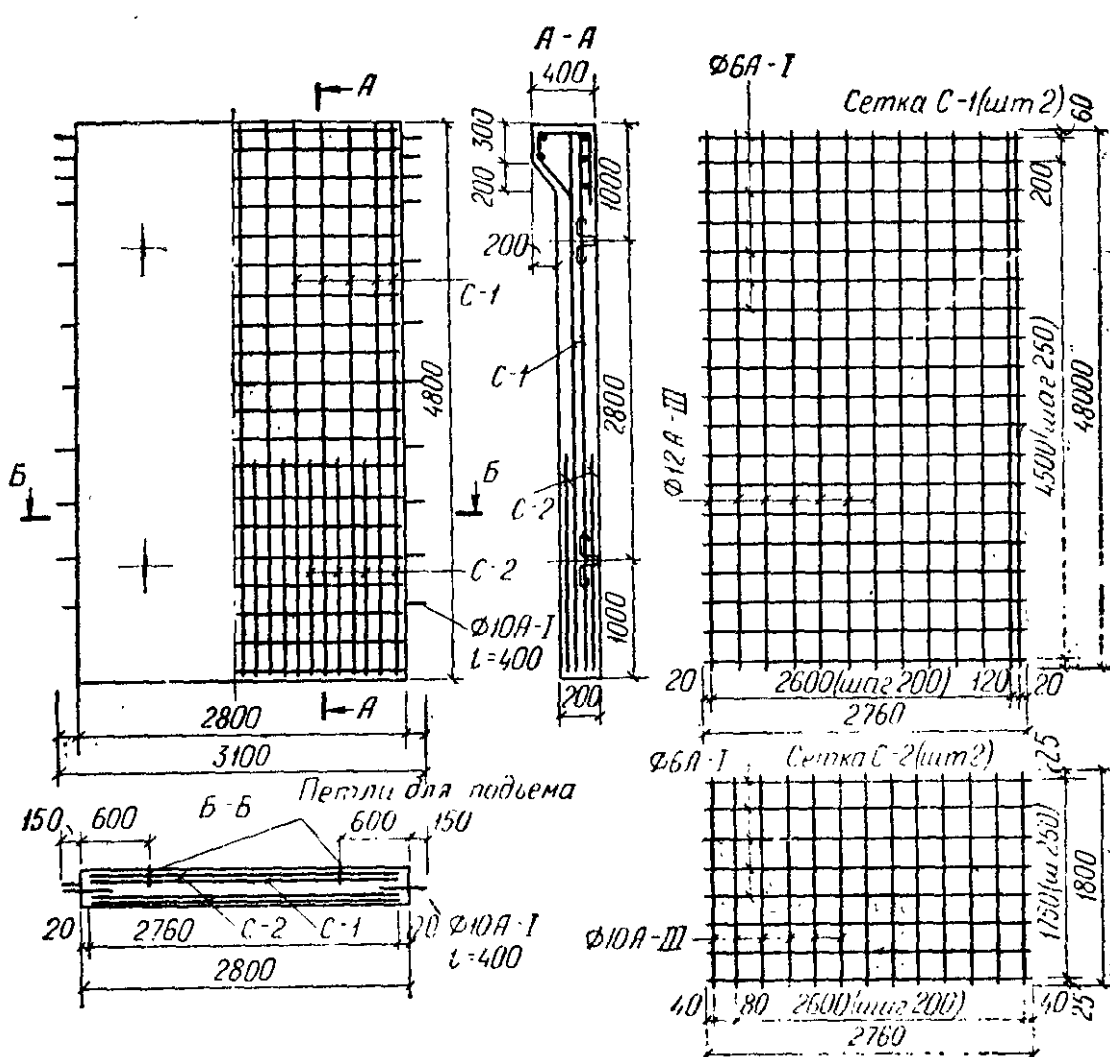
Армирование стеновой панели прямоугольного резервуара
